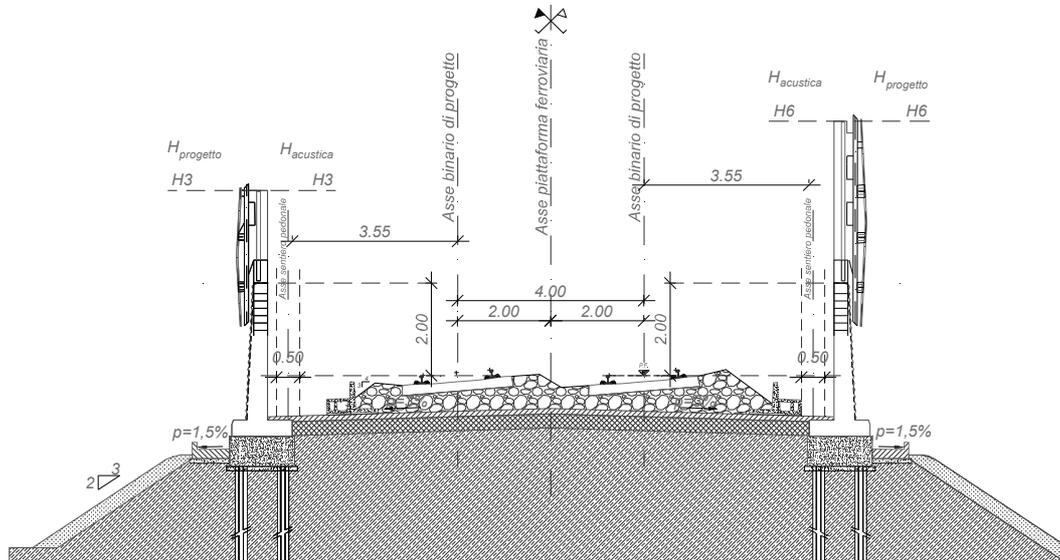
Sezione tipo tipologica BA “HS” rettificato con manufatto prefabbricato su rilevato
